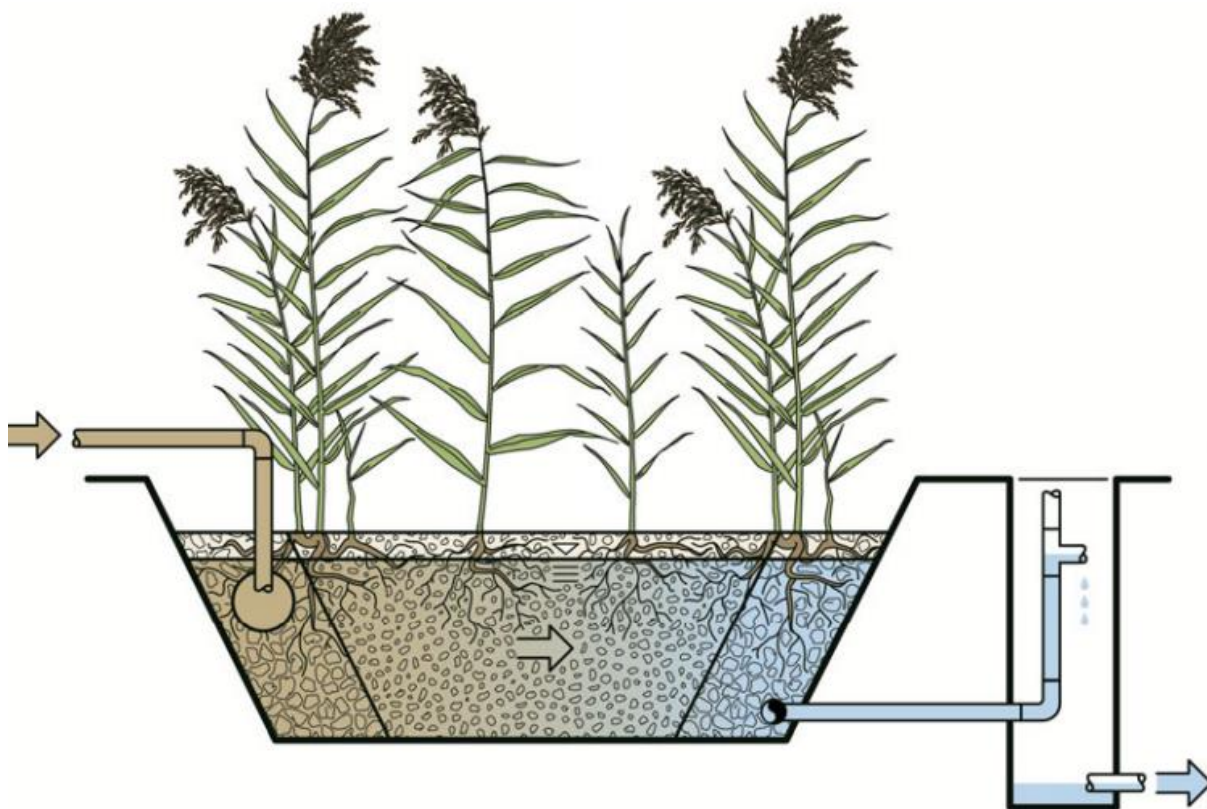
Sistema alagado construído de fluxo subsuperficial horizontal (SACFH).
